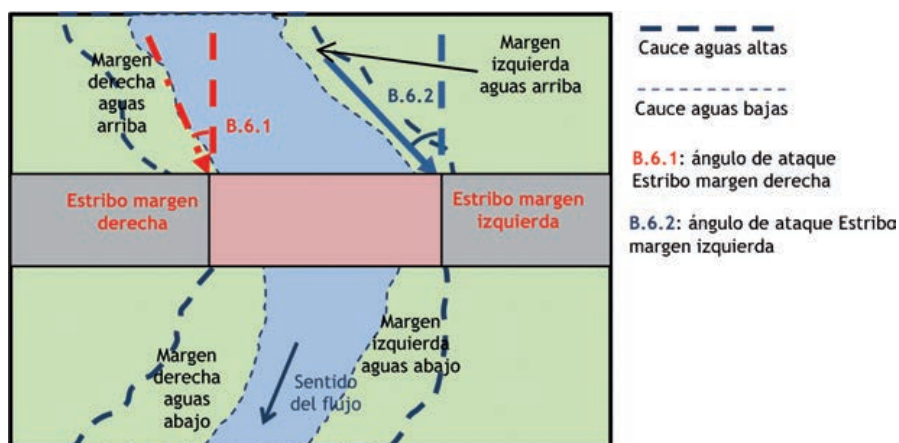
ÁNGULO DE ATAQUE SOBRE LOS ESTRIBOS.
